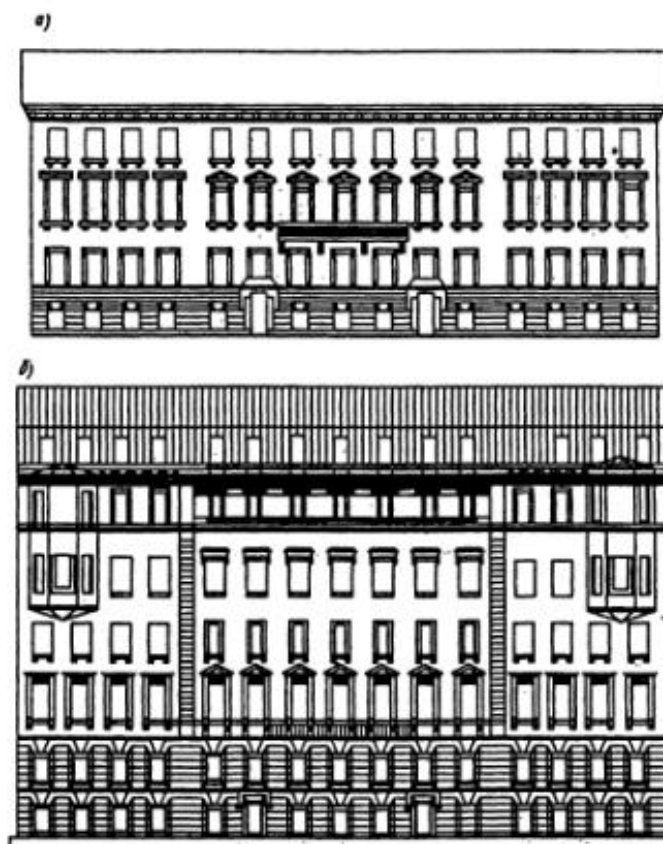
С.-Петербург. Жилое здание исторической застройки: а - первоначальный фасад; б - фасад после реконструкции и надстройки.
